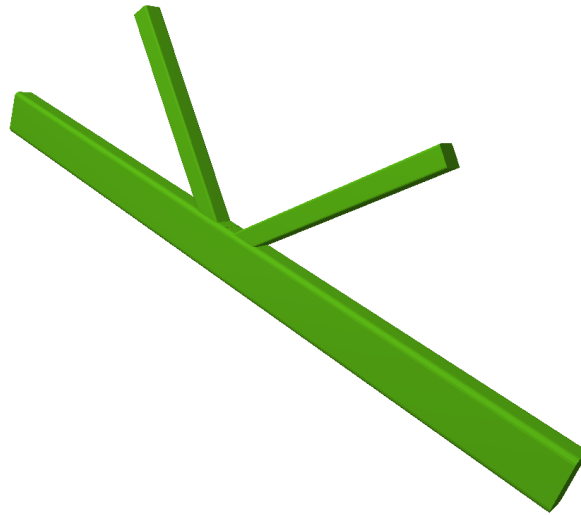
Detalla de Union Cordon Inferior-Diagonal, Elaboracion Propia
